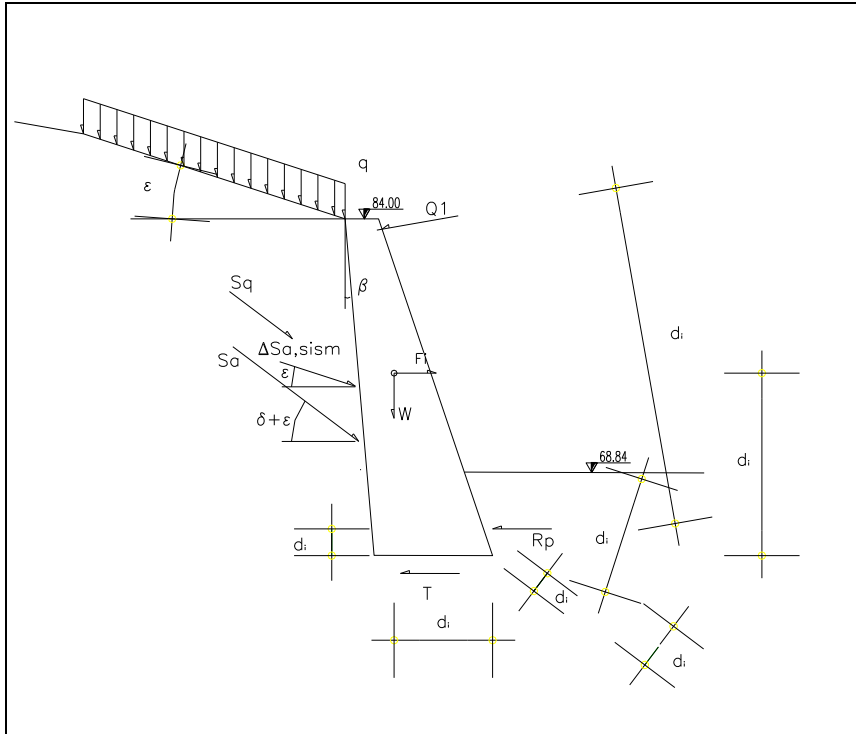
Schema delle forze e dei bracci rispetto allo spigolo esterno della fondazione – Caso sismico
